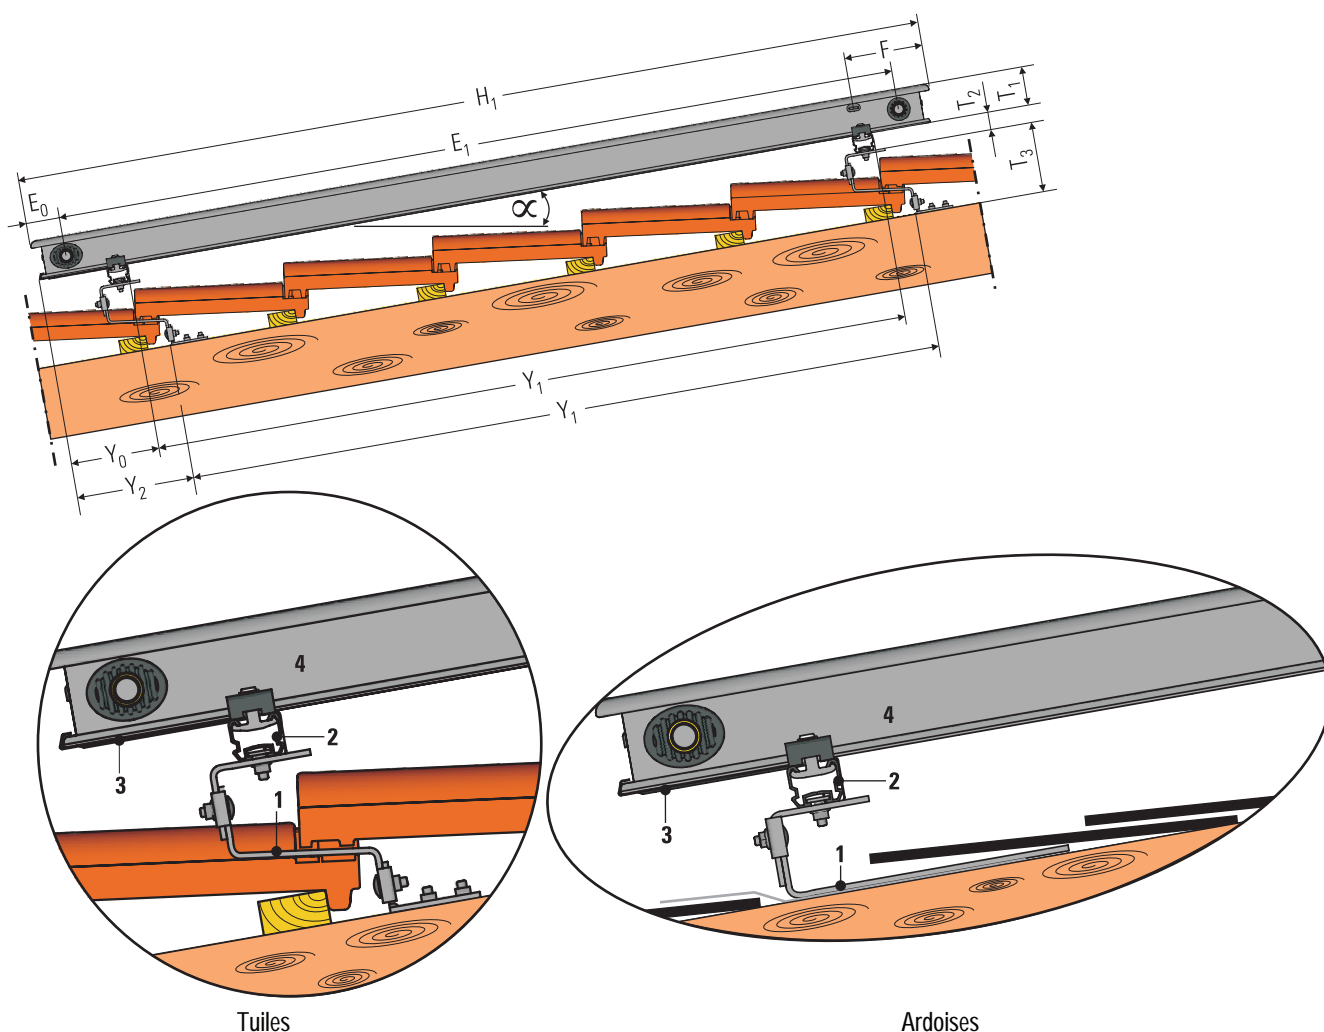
Dimensions principales d'un groupe de capteurs solaires pour montage sur toiture (exemple du capteur solaire EKSV26P)
